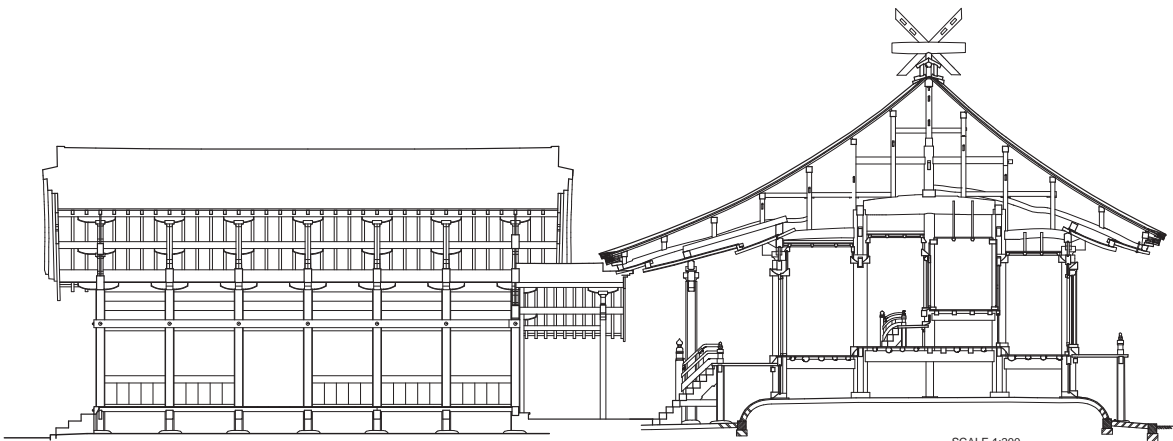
a-9 宗像大社辺津宮 本殿・拝殿 平面断面図
